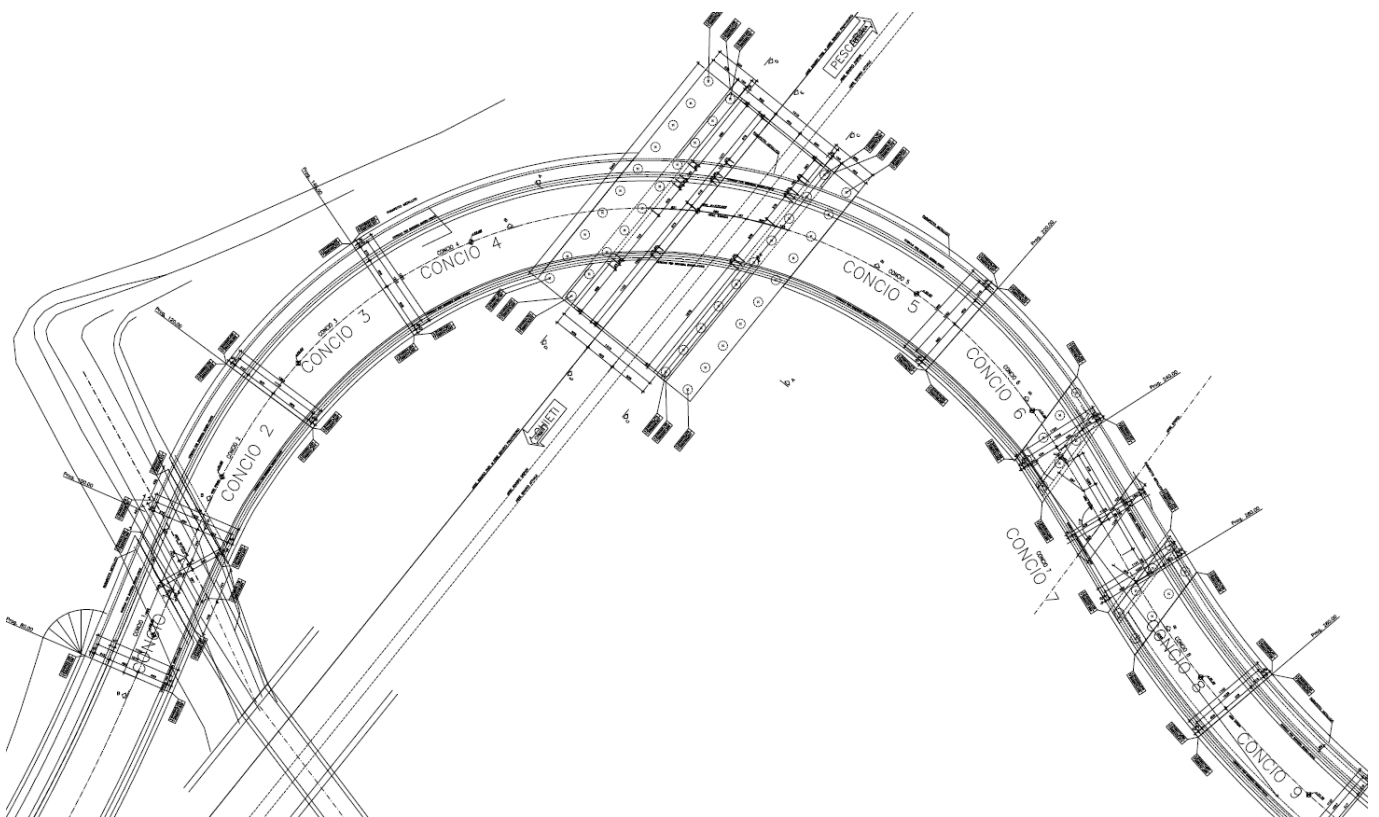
Ubicazione dell'intervento - Stralcio planimetrico
